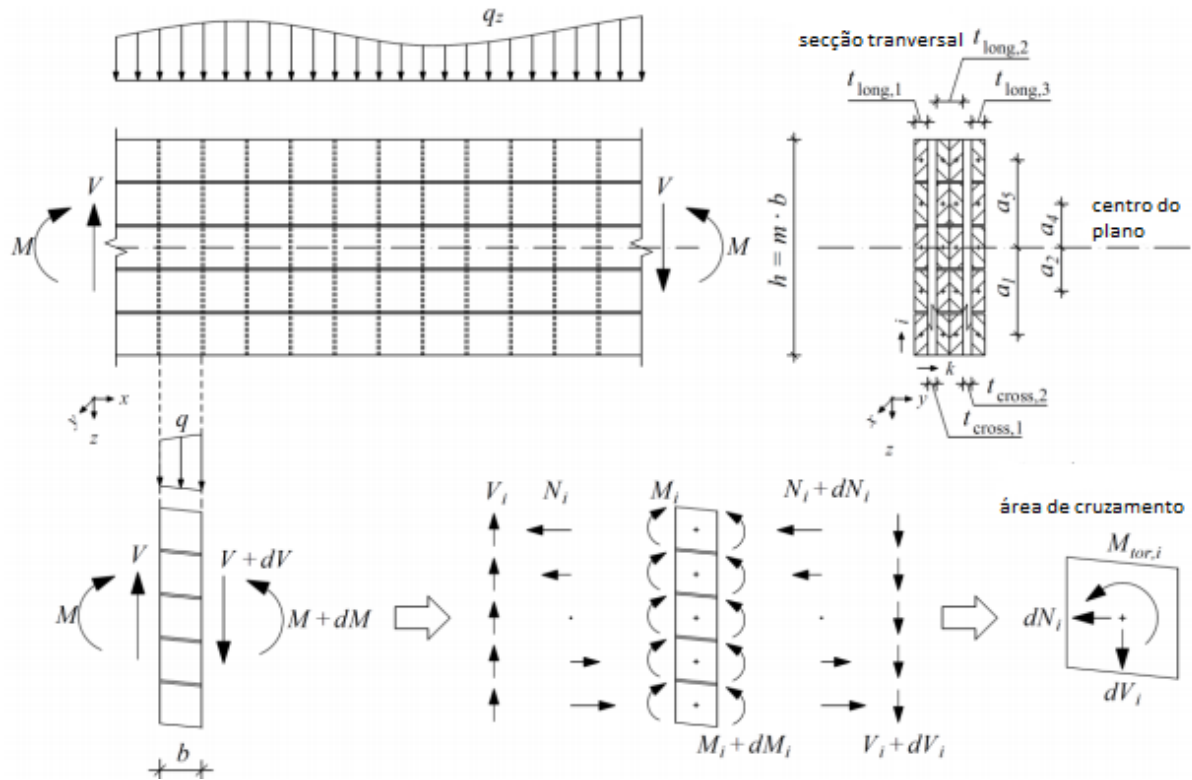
Vista lateral e a secção transversal da viga CLT com 4 camadas carregadas no plano (topo) e forças internas na viga em lamelas individuais e nas áreas de cruzamento (M Flaig & Blaß, 2012).
